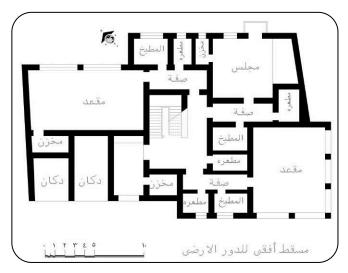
مسقط أفقى للدور الأرضى لرباط داود باشا في (شكل 7) مسقط أفقى للدور الأول لرباط داود باشا في ضوء وصف وثيقة الوقف (عمل الباحث)
